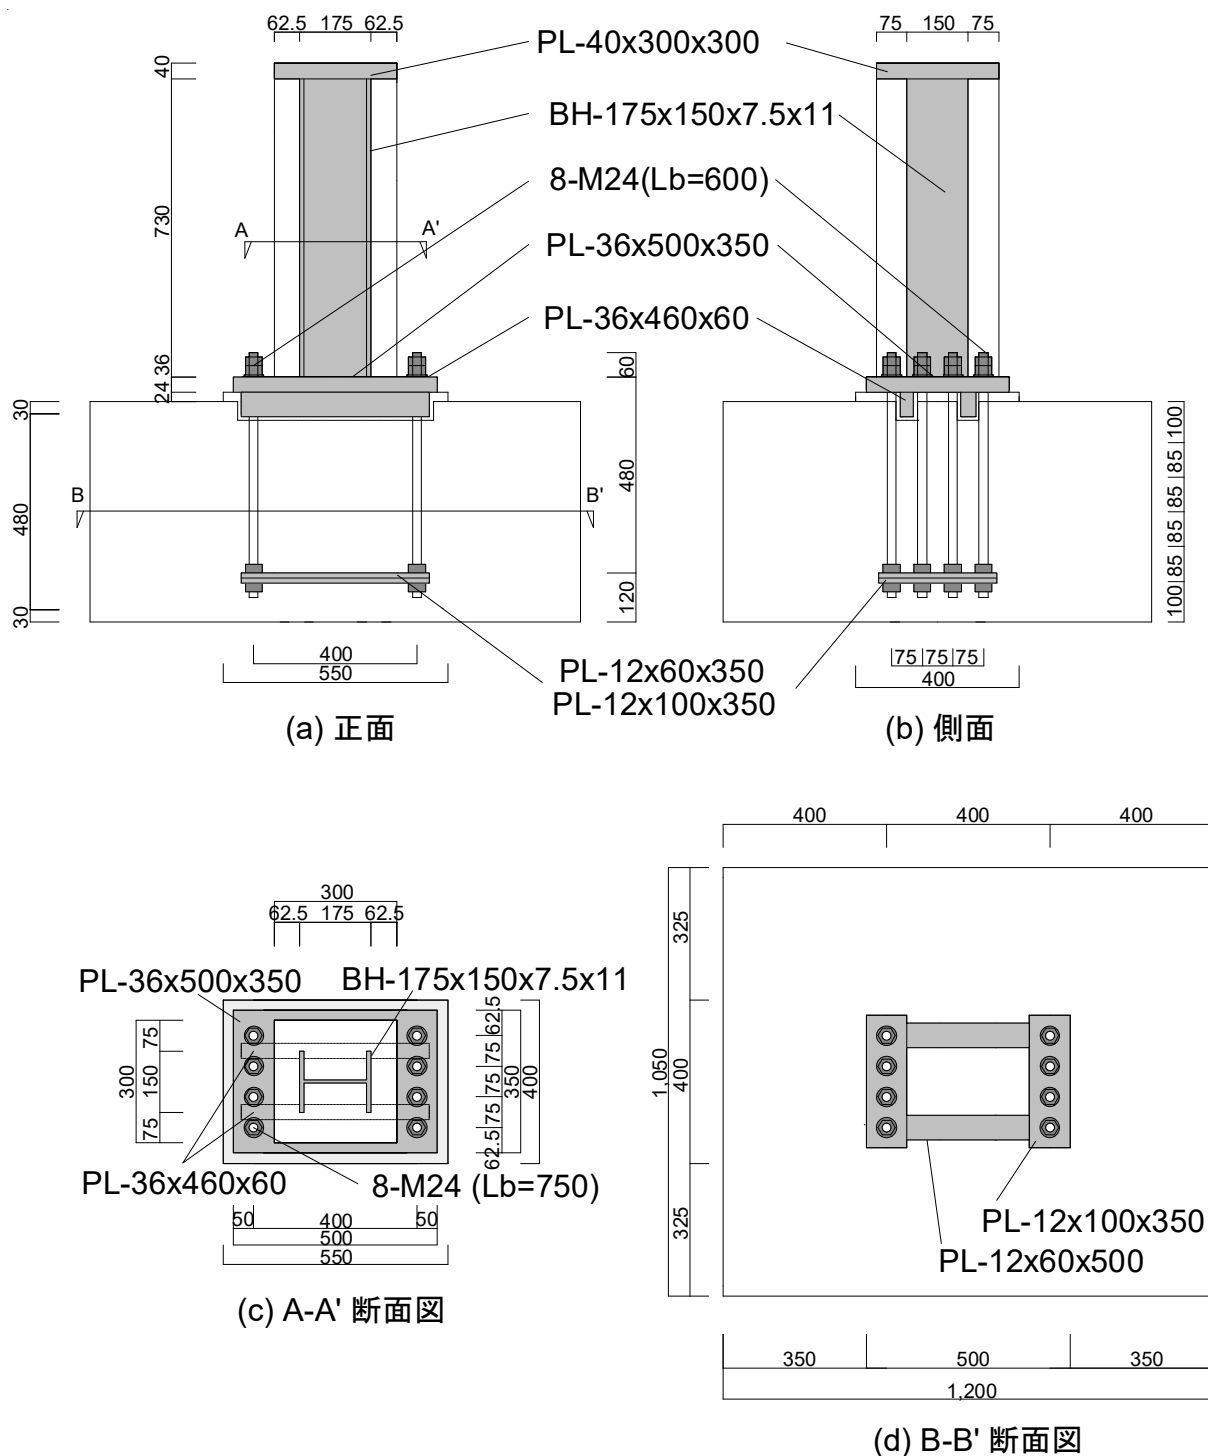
(d) 試験体鉄骨および AB 配置状況 (試験体 A500)
